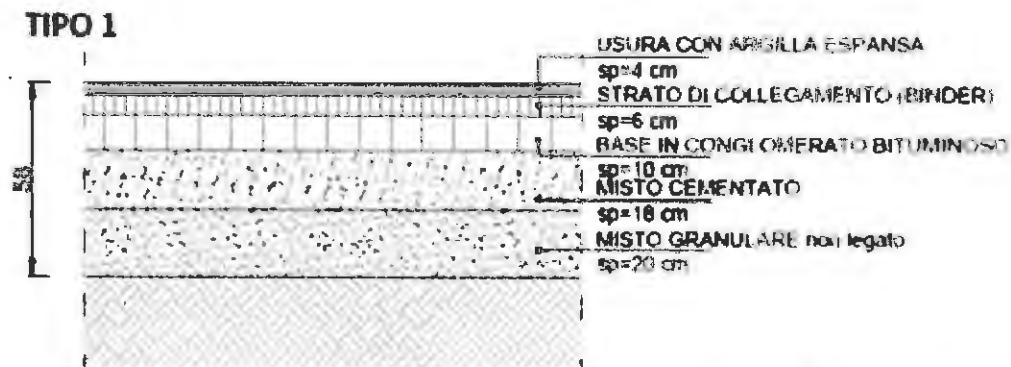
Sezione TIPO 1 progetto esecutivo – Asta principale SS131 e Rampe Svincolo Nord
